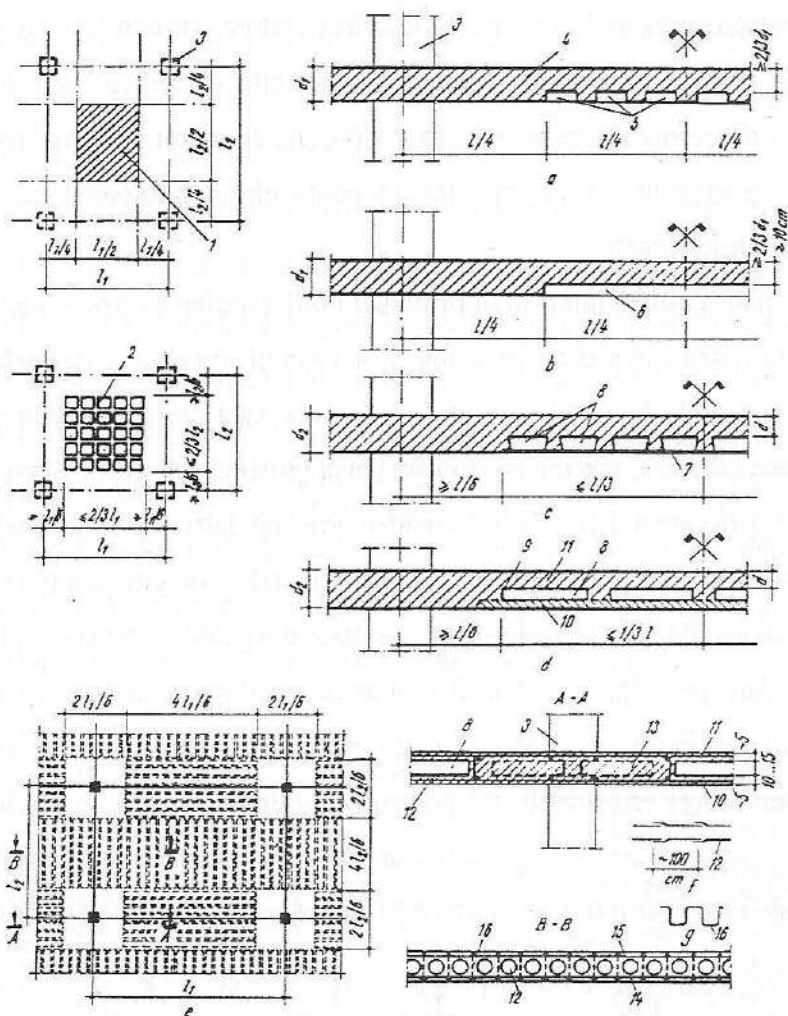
Soluții constructive pentru reducerea consumului de beton în zona comună a fâșiilor de câmp din dala groasă:
